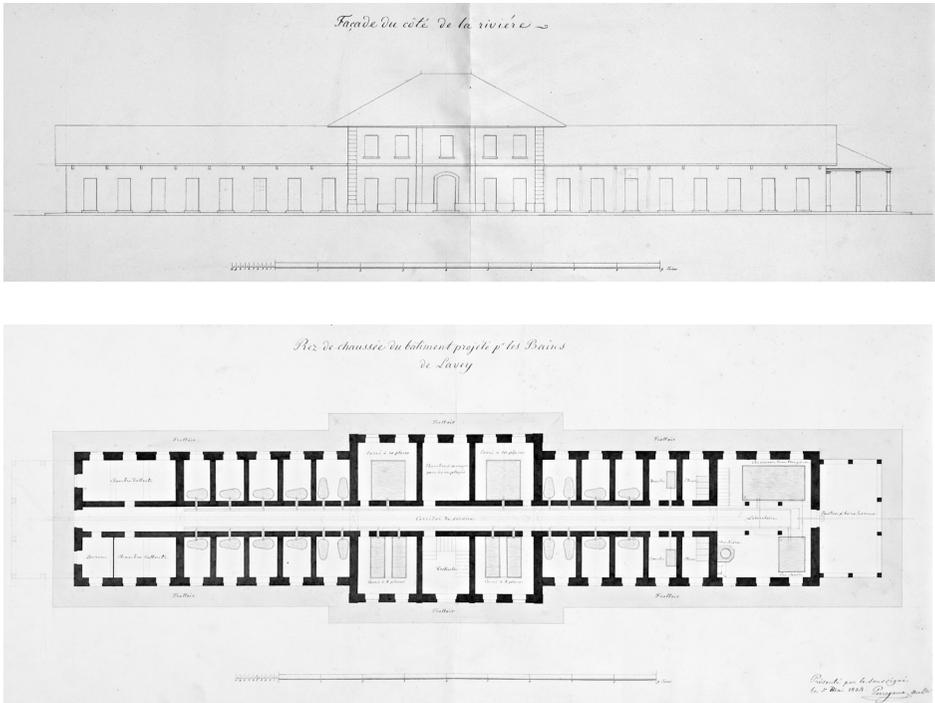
Lavey, bains, projet d'Henri Perregaux, plan et élévation, 1834 (ACV).
